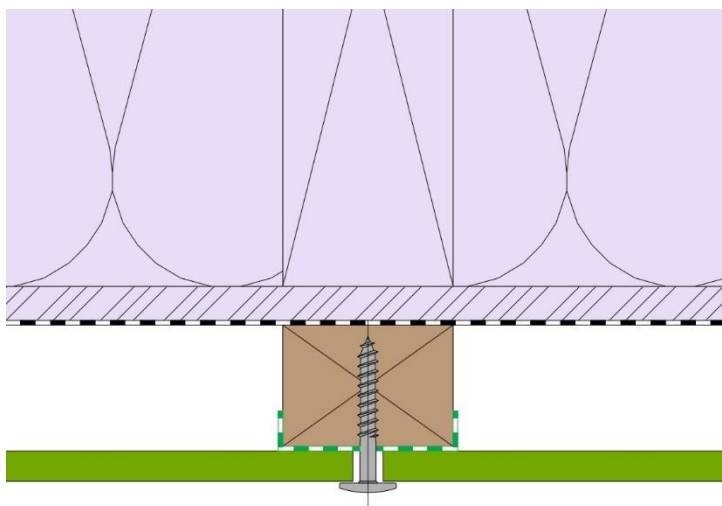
Exemple de point dilatant – fixation par vis sur tasseau – coupe horizontale
